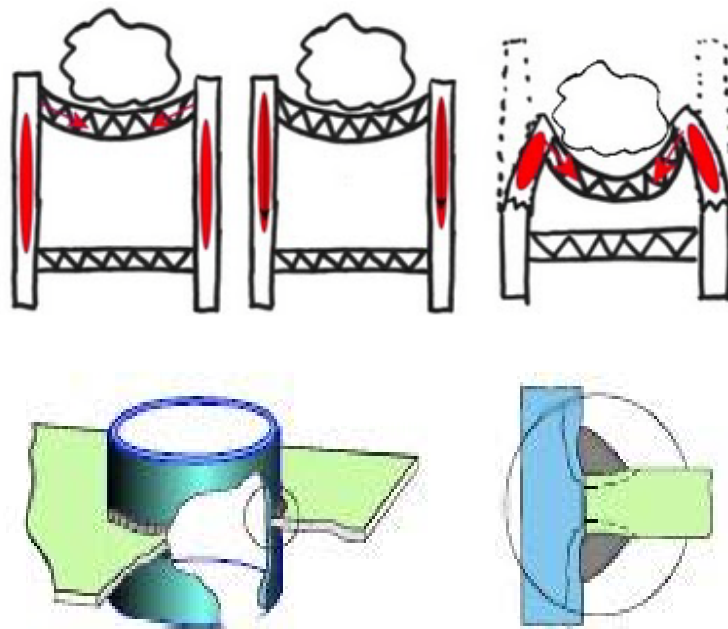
, falla por aplastamiento y por desgarramiento laminar en columnas de acero
